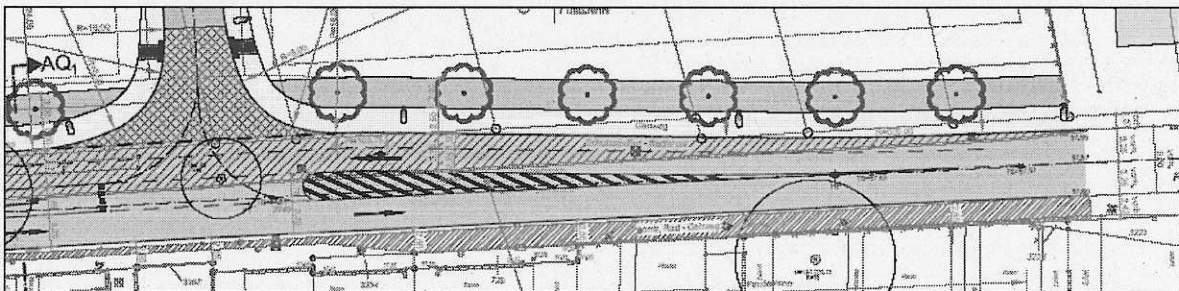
Lageplanausschnitt – Erschließung B-Plan Nr. 416 Fasanenweg
